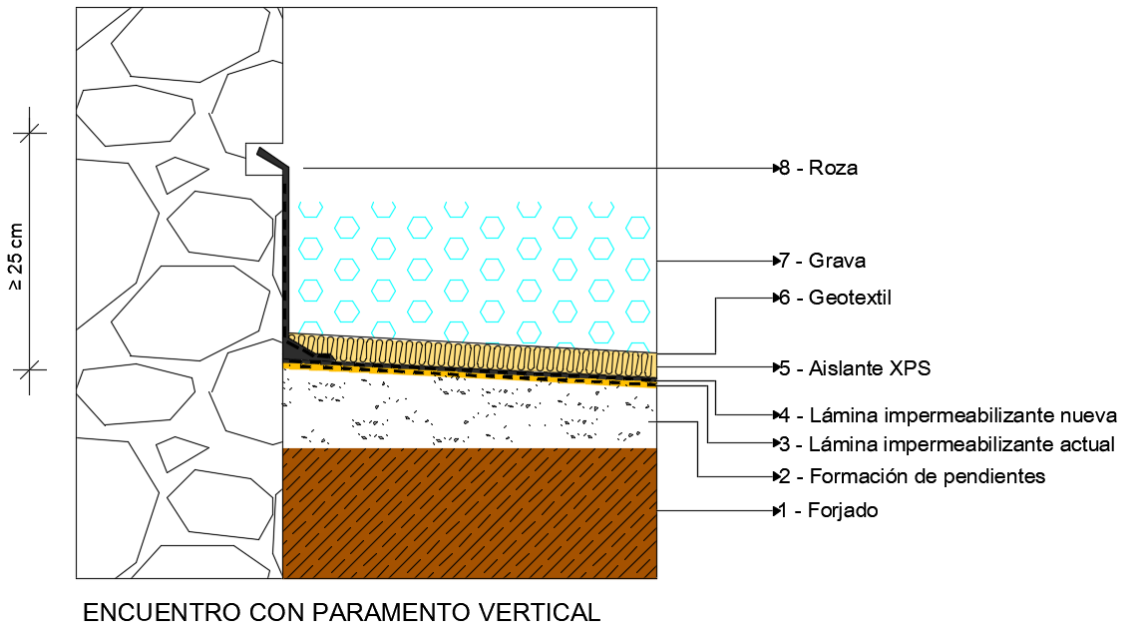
Detalle encuentro cubierta plana y paramento vertical. Fuente: www.isower.es y modificación propia, creación 08/07/2019
